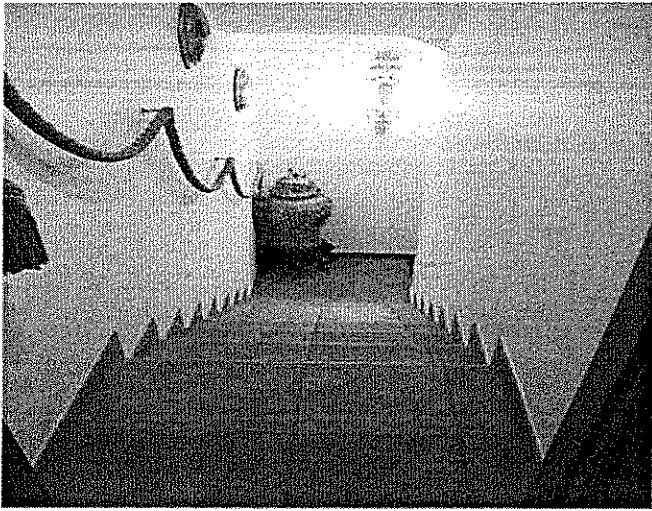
e 38 -Particolare Scala di Collegamento P.T. con il P.S.1° -Particolare Interno Garage al P.S.1°.
